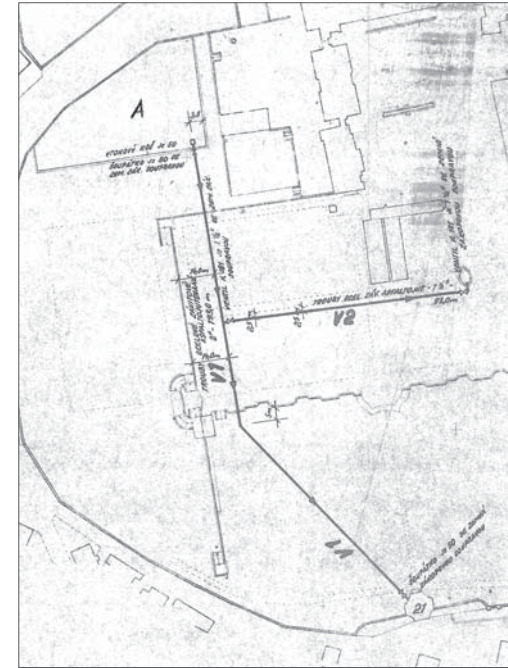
Plan zur Neuregelung der Wasserführung, „Zajisti Akce Kloster Osek - Vodovod II. Cast“, Ausschnitt Konventgarten, 1967, Staatliches Denkmalmamt Ústí n.L., Planarchiv.
